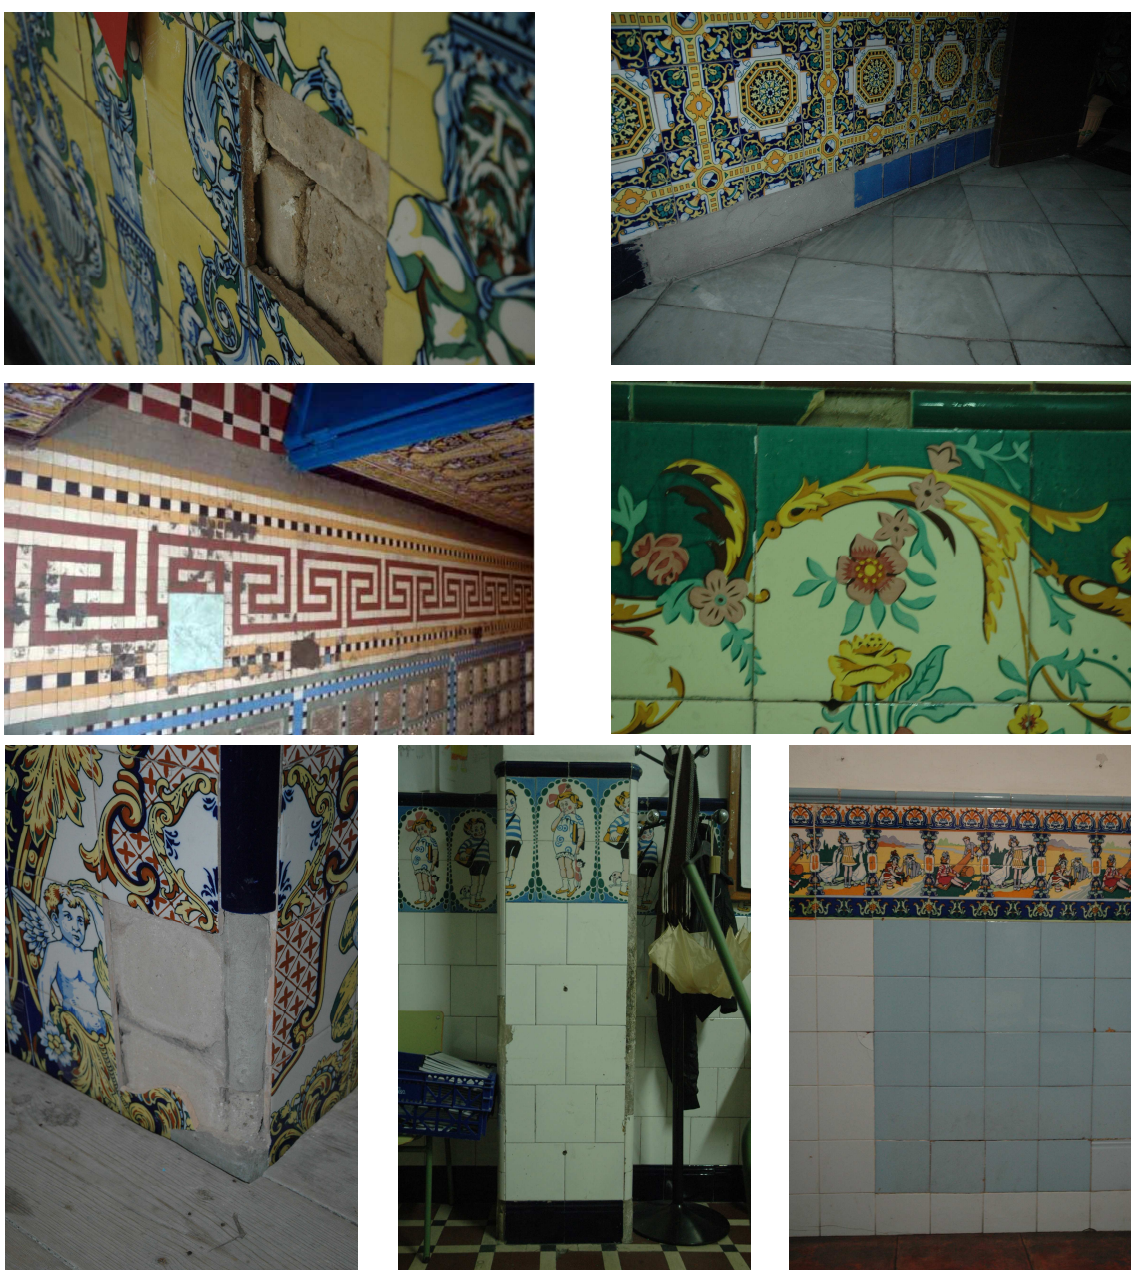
Estado de los arrimaderos y pavimentos. Fuente propia
